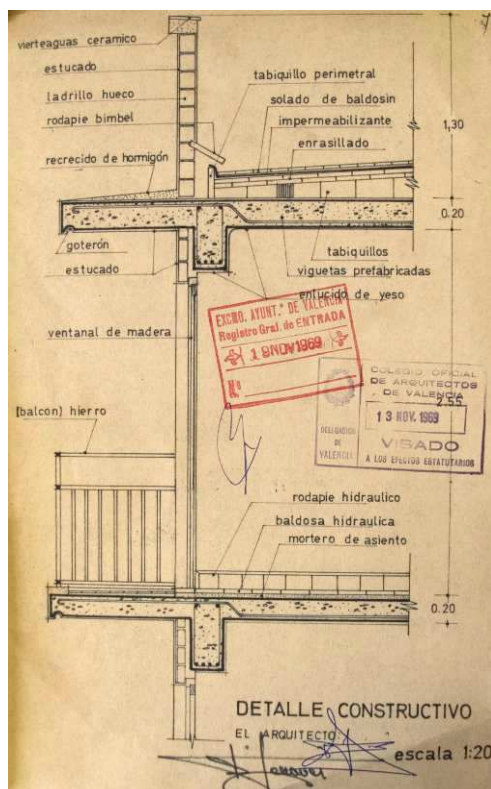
Detalle constructivo de fachada. Edificio ficha 205A.006, 1969.
